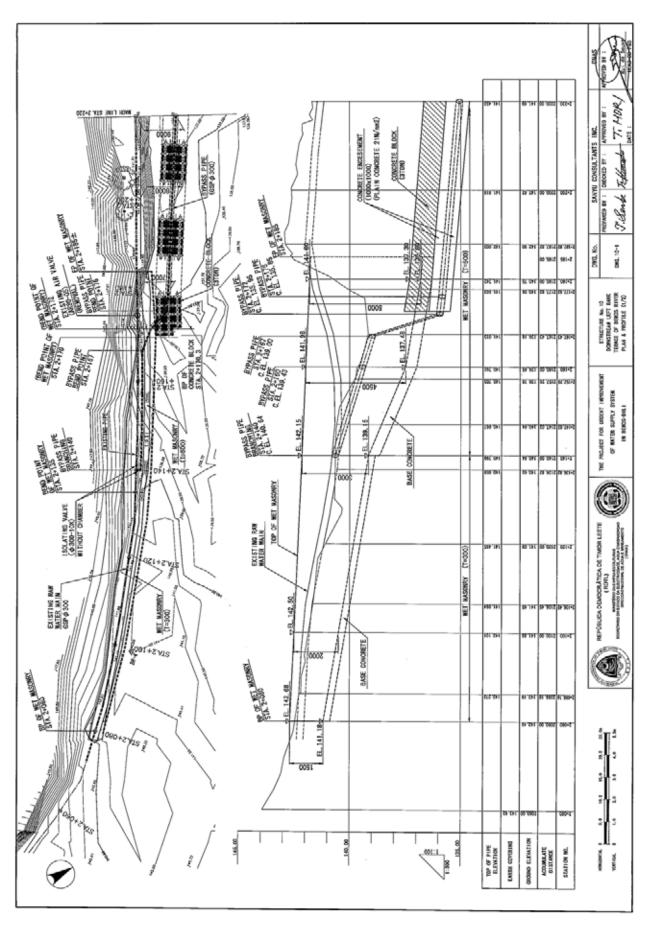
改修箇所 No. 11: ベモス川左岸側斜面山脚部 計画縦平面図 (その1)
